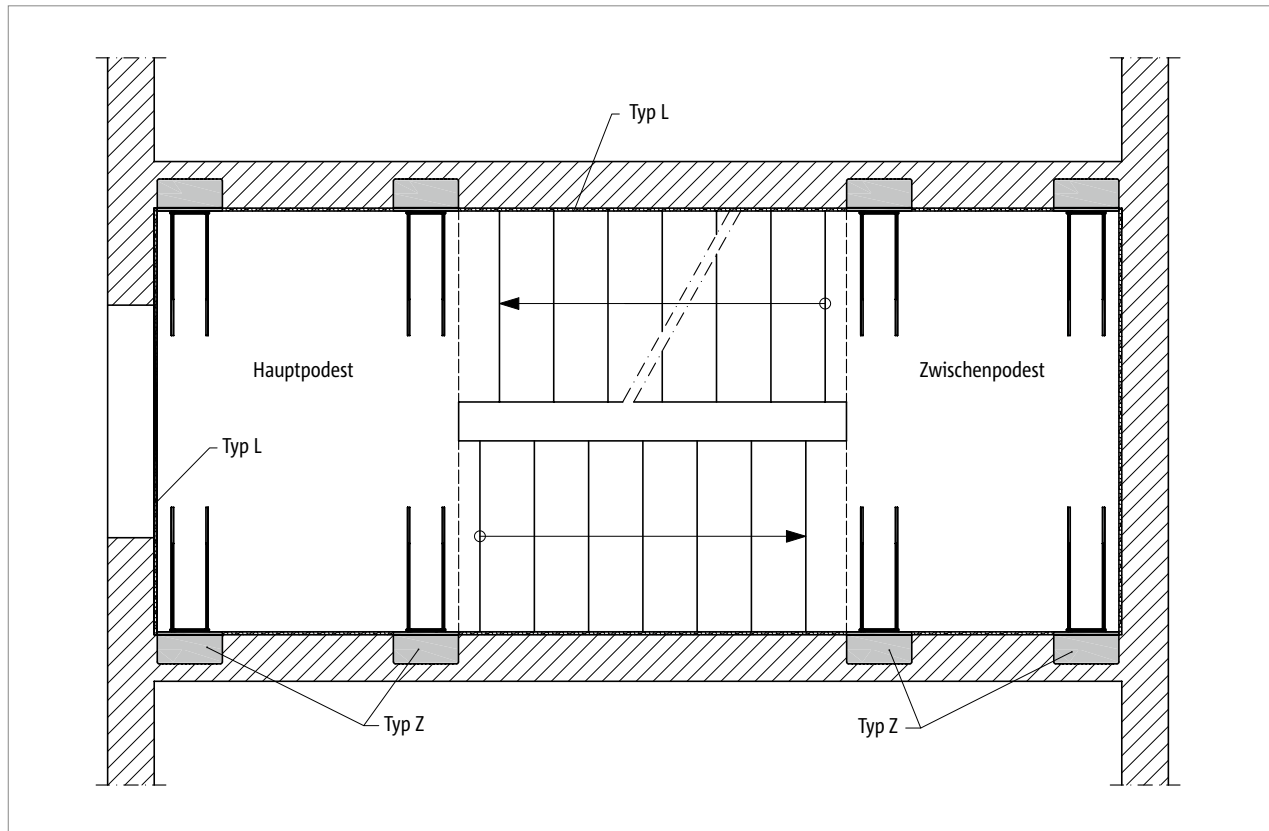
Schöck Tronsole® Typ Z: Elementanordnung im Grundriss
